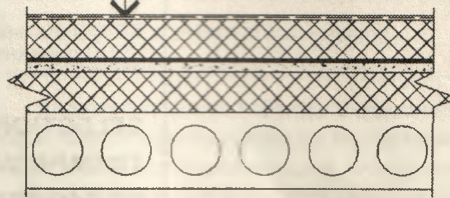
Конструктивное решение тепловой реабилитации существующей кровли
